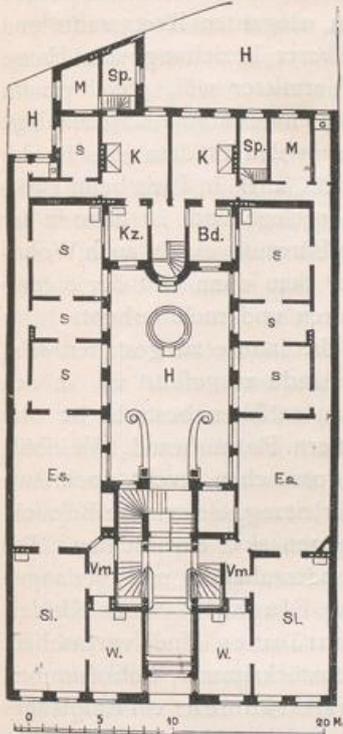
Miethaus in Dresden-Altstadt. Architekt: WEISSBACH.
